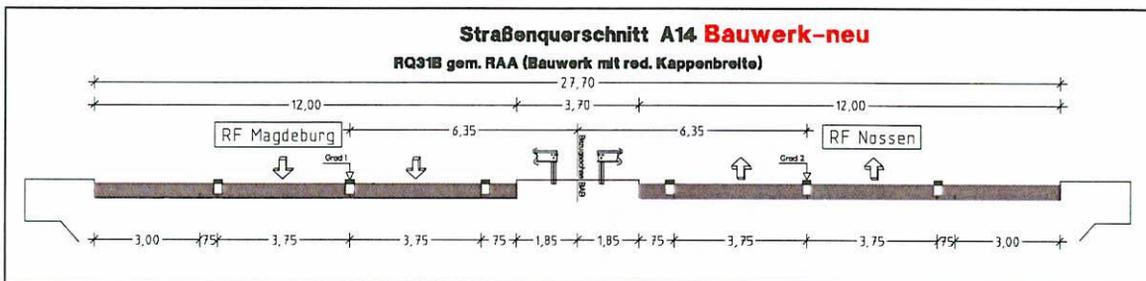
Geplanter Bauwerksquerschnitt RQ 31B
